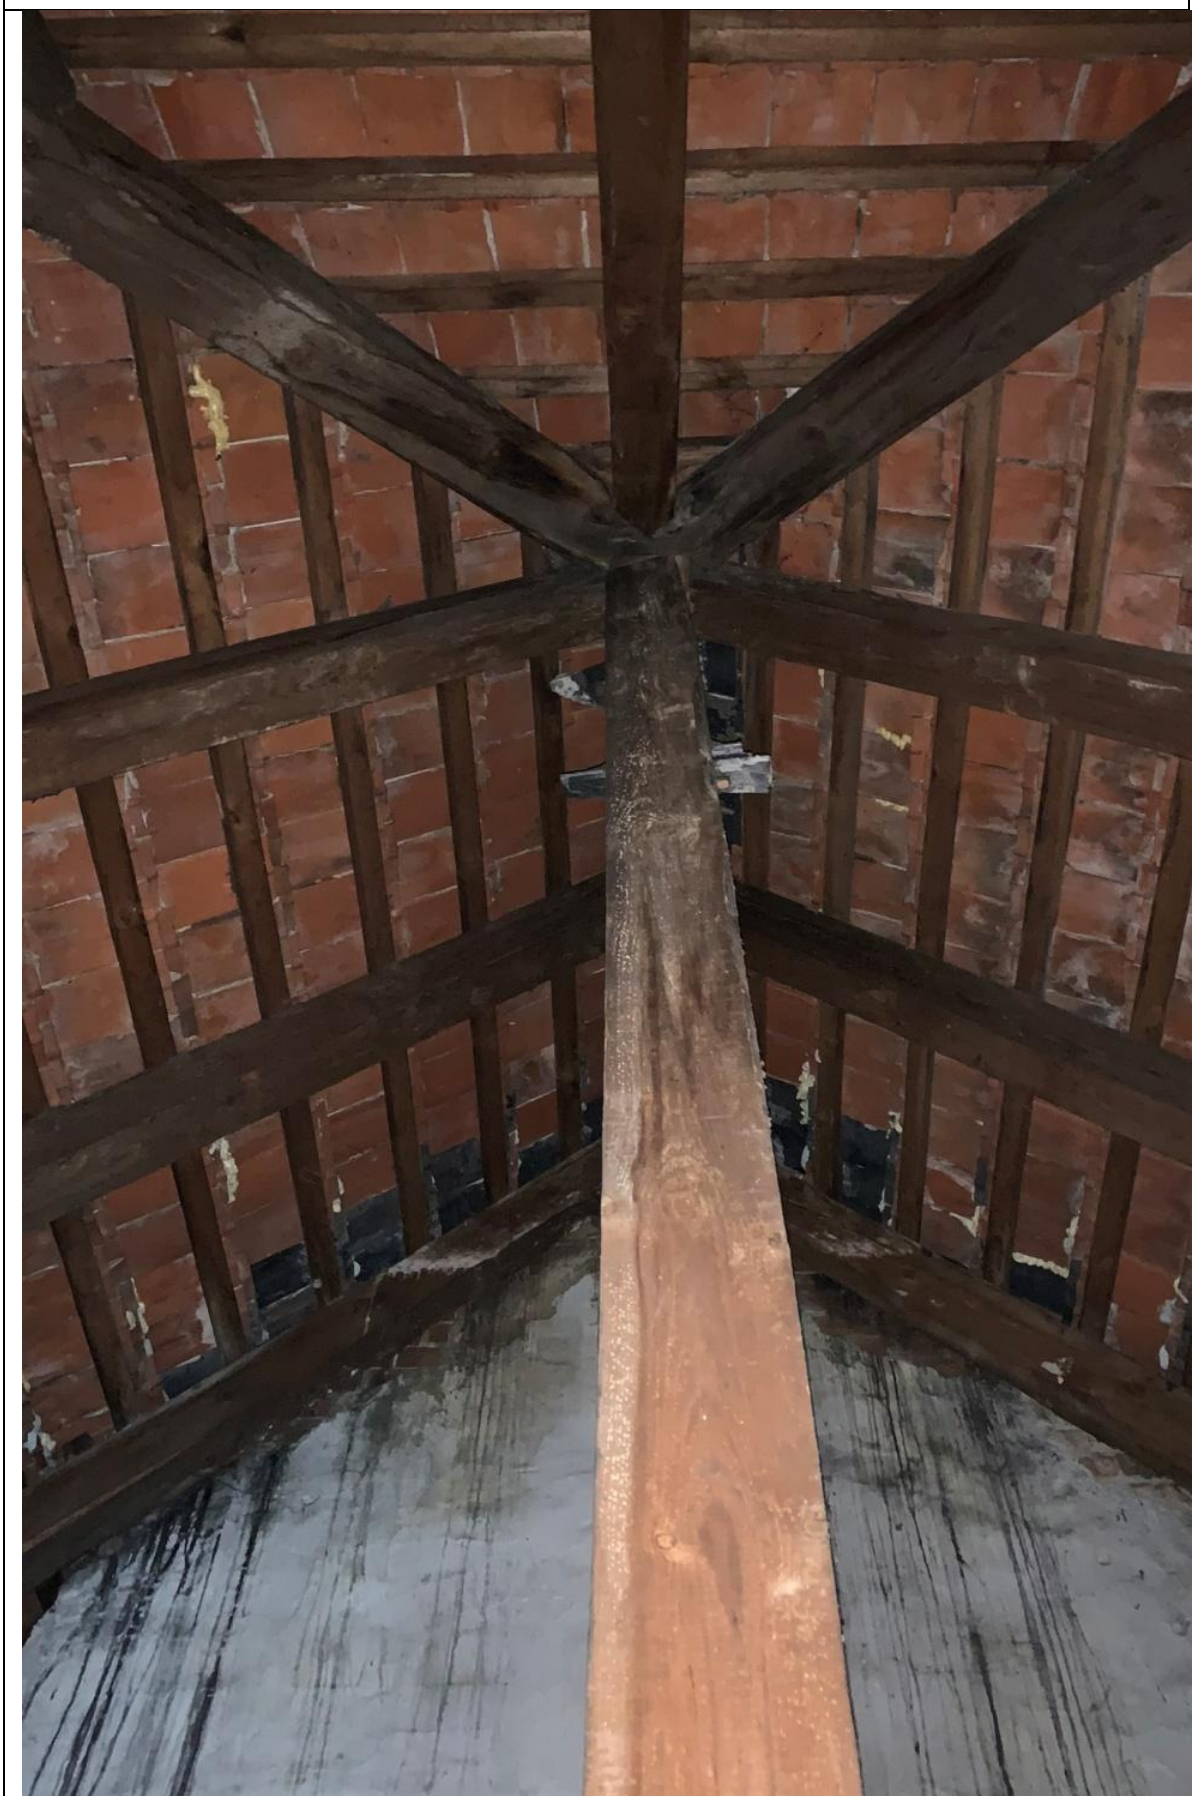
Widok na konstrukcję więźby dachowej – brak spękań, brak ubytków. Stan więźby bardzo dobry.
